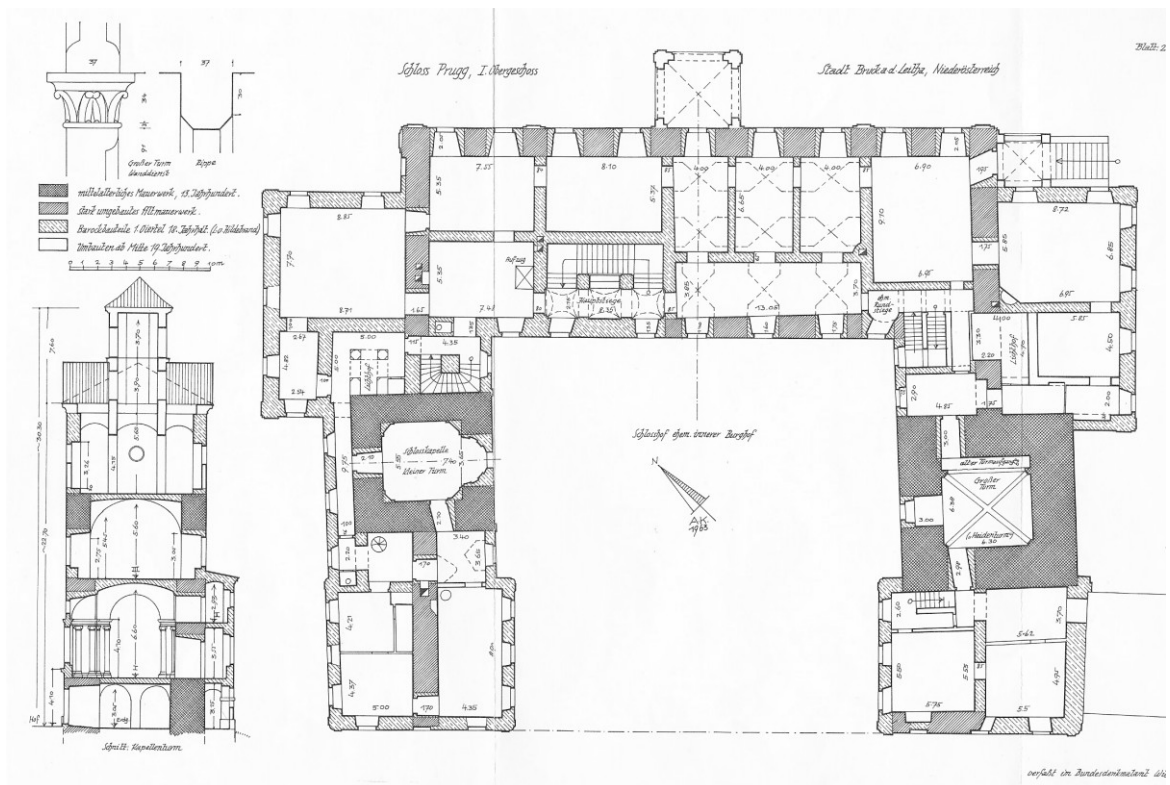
Baulterplan Schloss Prugg, Plan1, Blatt 2/I. Obergeschoss, A. Kloor, Bundesdenkmalamt Wien, 1973 (Quelle: KLAAR 1973)
